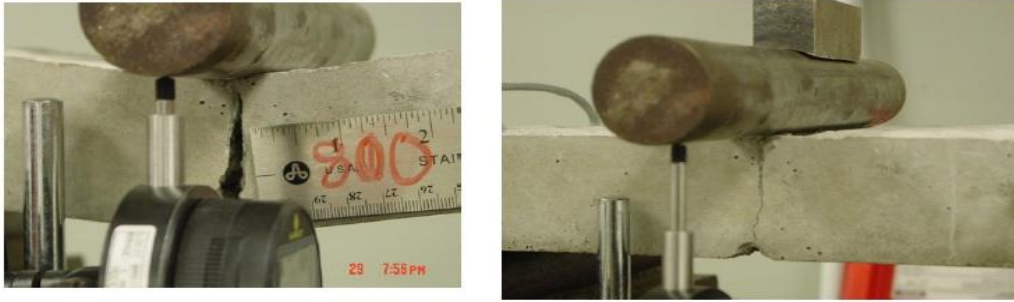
Estado da viga antes e depois do aquecimento dos cabos de LMF [77]
